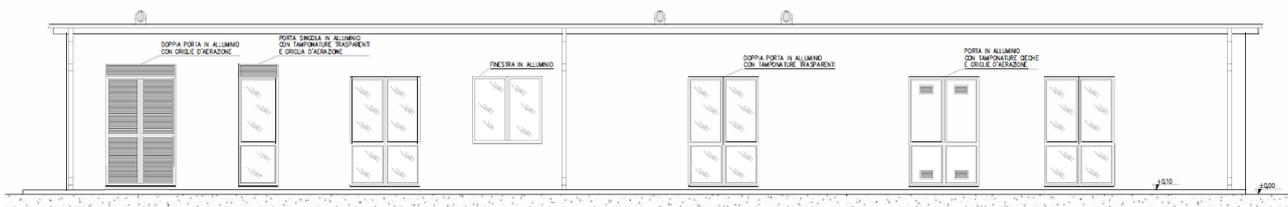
Architettonico fabbricato Cabina utente 150/30 kV – Prospetto
